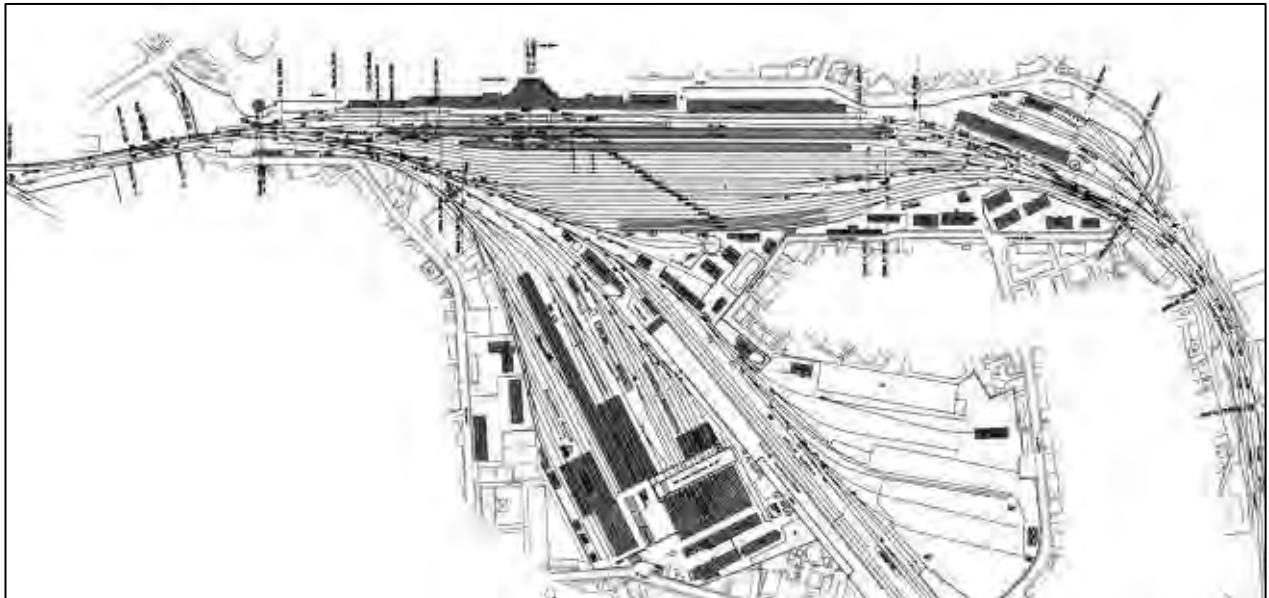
Planimetria schematica dell’area ferroviaria di Bolzano
